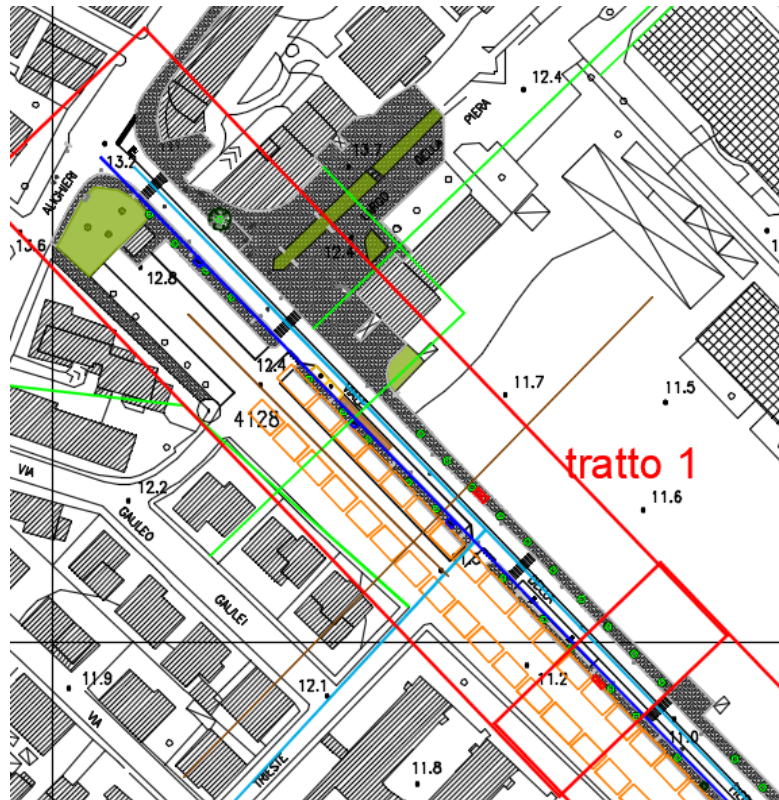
Planimetria dello Stato di fatto tratto 1 con i sottoservizi
